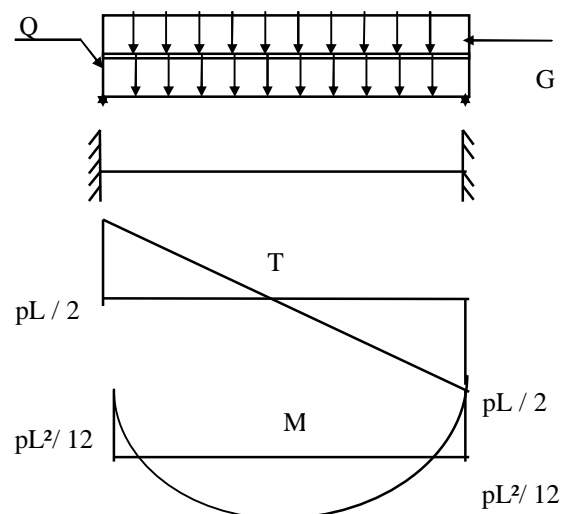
les sollicitations revenant aux linteaux.
